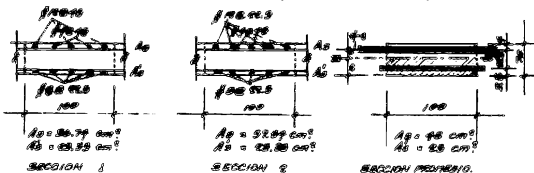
DETALLES DE LA ESTRUCTURA PROTOTIPO.
